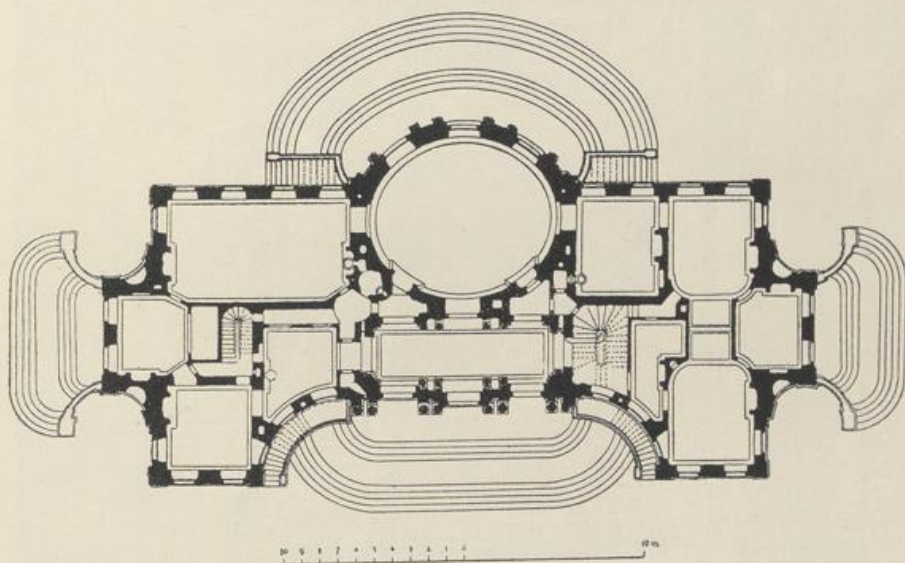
Grundriss des Schlosses Monrepos bei Ludwigsburg
